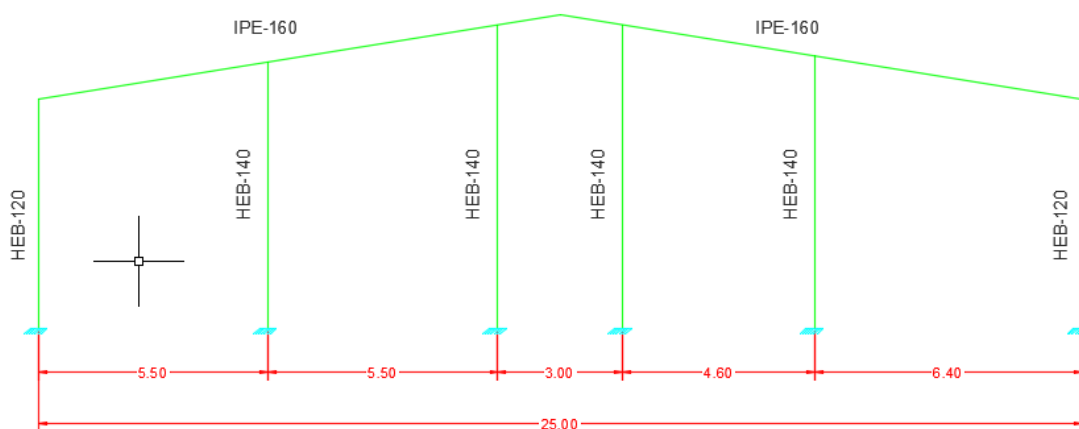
Dimensiones pórtico hastial y perfiles de pilares y vigas. (CYPE, 2014).
